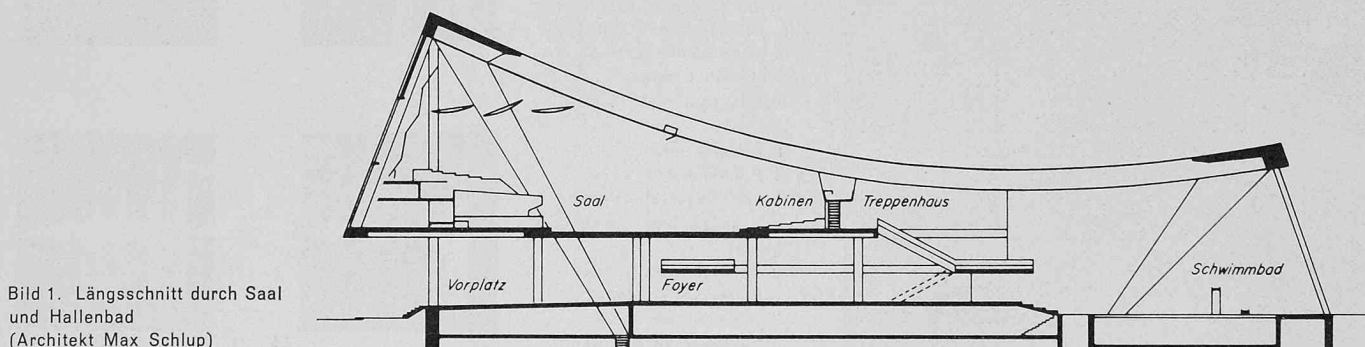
Längsschnitt durch Saal und Hallenbad (Architekt Max Schlup)
